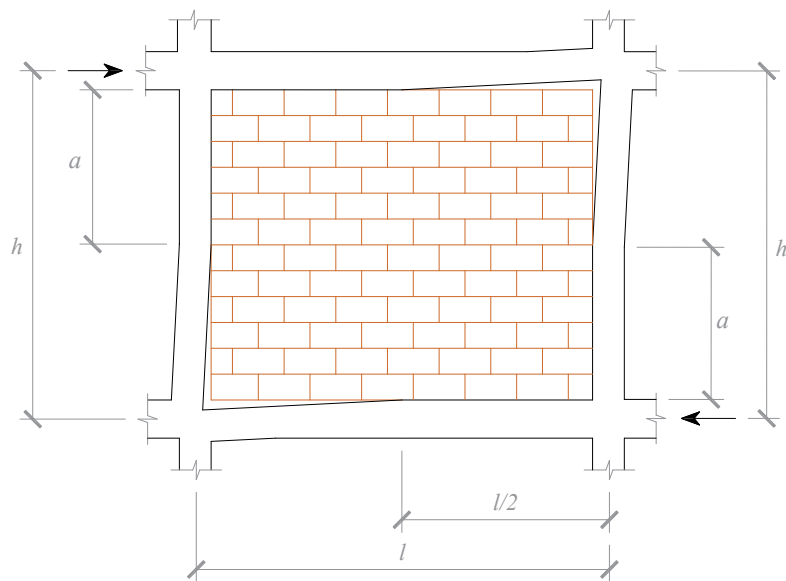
Interação entre a estrutura reticulada e a parede, sob a ação de forças horizontais.
